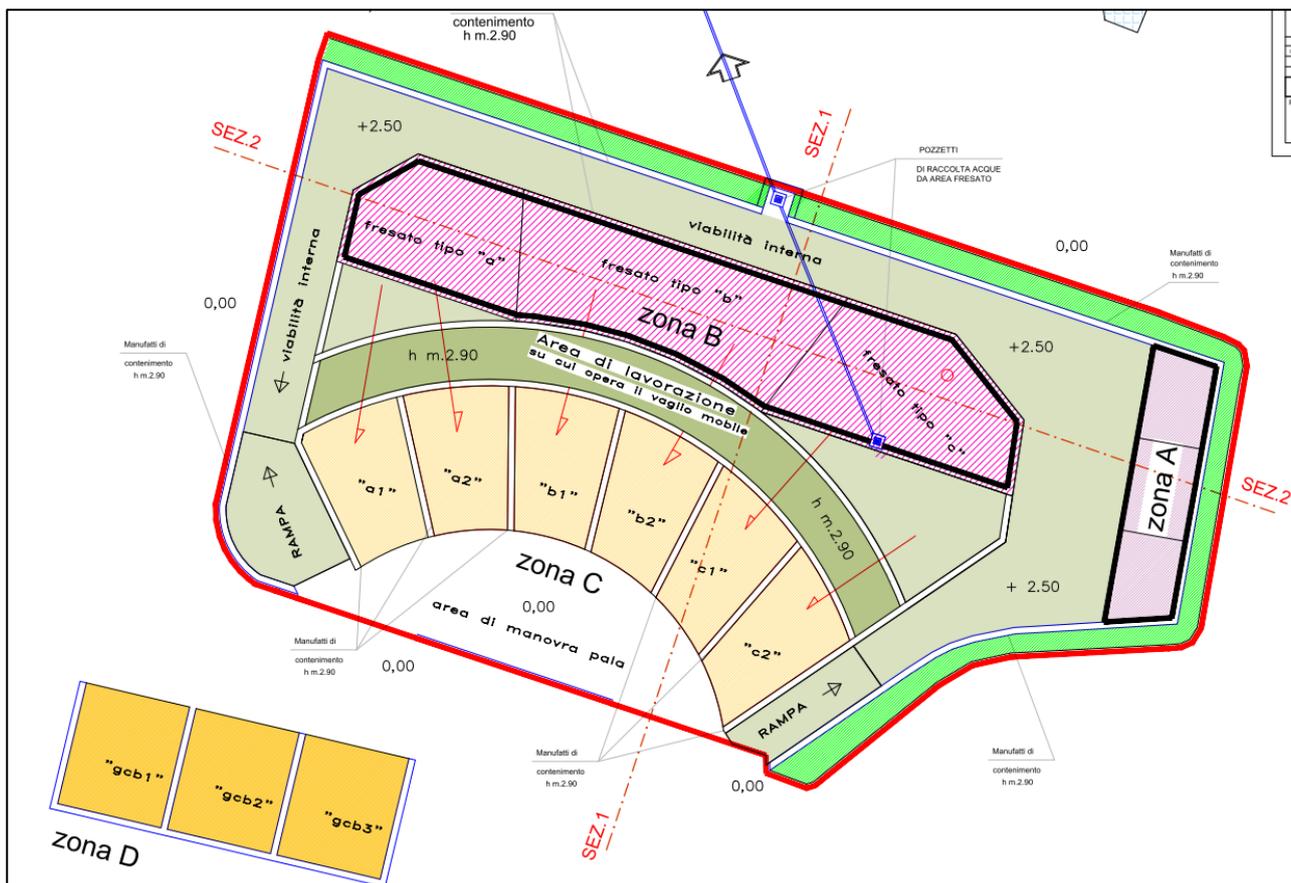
Stralcio della planimetria dell’impianto di recupero; la configurazione dell’impianto non subirà modifiche rispetto alla situazione attuale (scala grafica).
